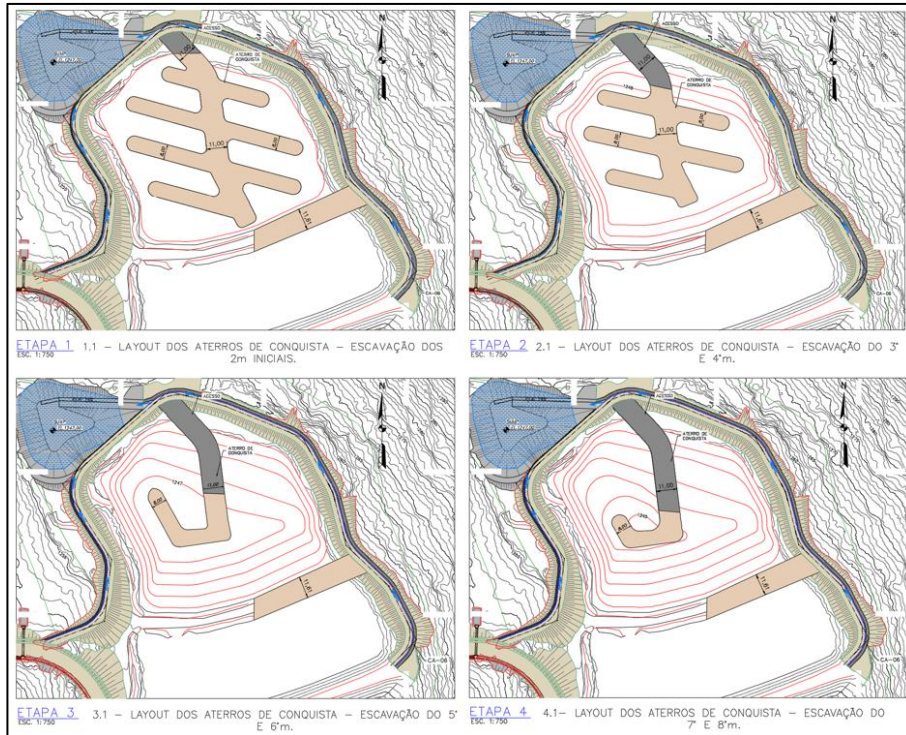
Arranjos de aterro de conquista – Fase 1 – Projeto executivo
